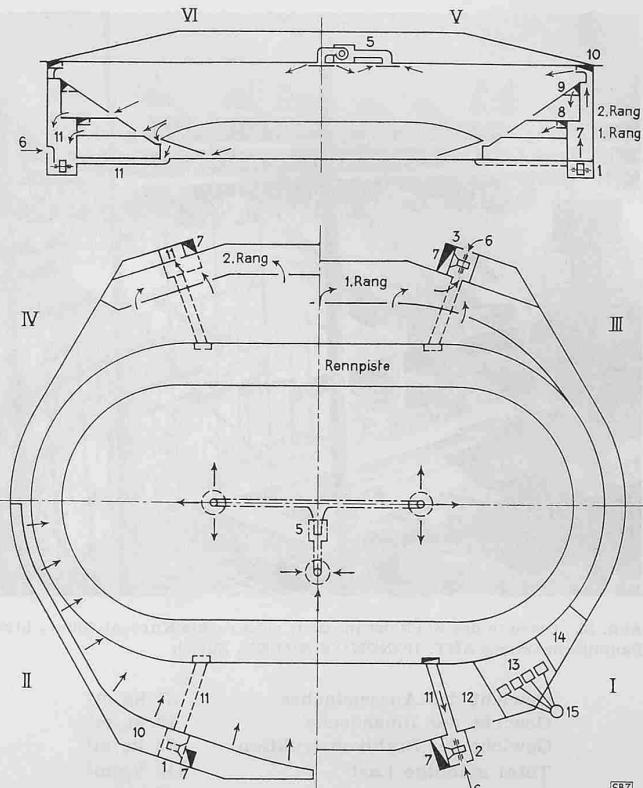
Ventilationsschema, I Grundriss Erdgeschoss, II Grundriss auf der Höhe des Ringkanals 10 unter der Decke, III Grundriss 1. Rang, IV Grundriss 2. Rang, V Querschnitt durch den Zuluftschacht, VI Querschnitt durch den Umluftschacht. 1 Ventilator, 2 Saugkammer, 3 Druckkammer, 5 Dachheizanlage, 6 Frischluftfeintritt, 7 Zuluftschächte, 8 Zuluft-Verteilkanal 1. Rang, 9 Zuluft-Verteilkanal 2. Rang, 10 Zuluft-Ringkanal, 11 Rückluftkanal, 12 Kohlen, 13 Kessel, 14 Heizwasser-Pumpe und Verteilbatterie, 15 Hochkamin
